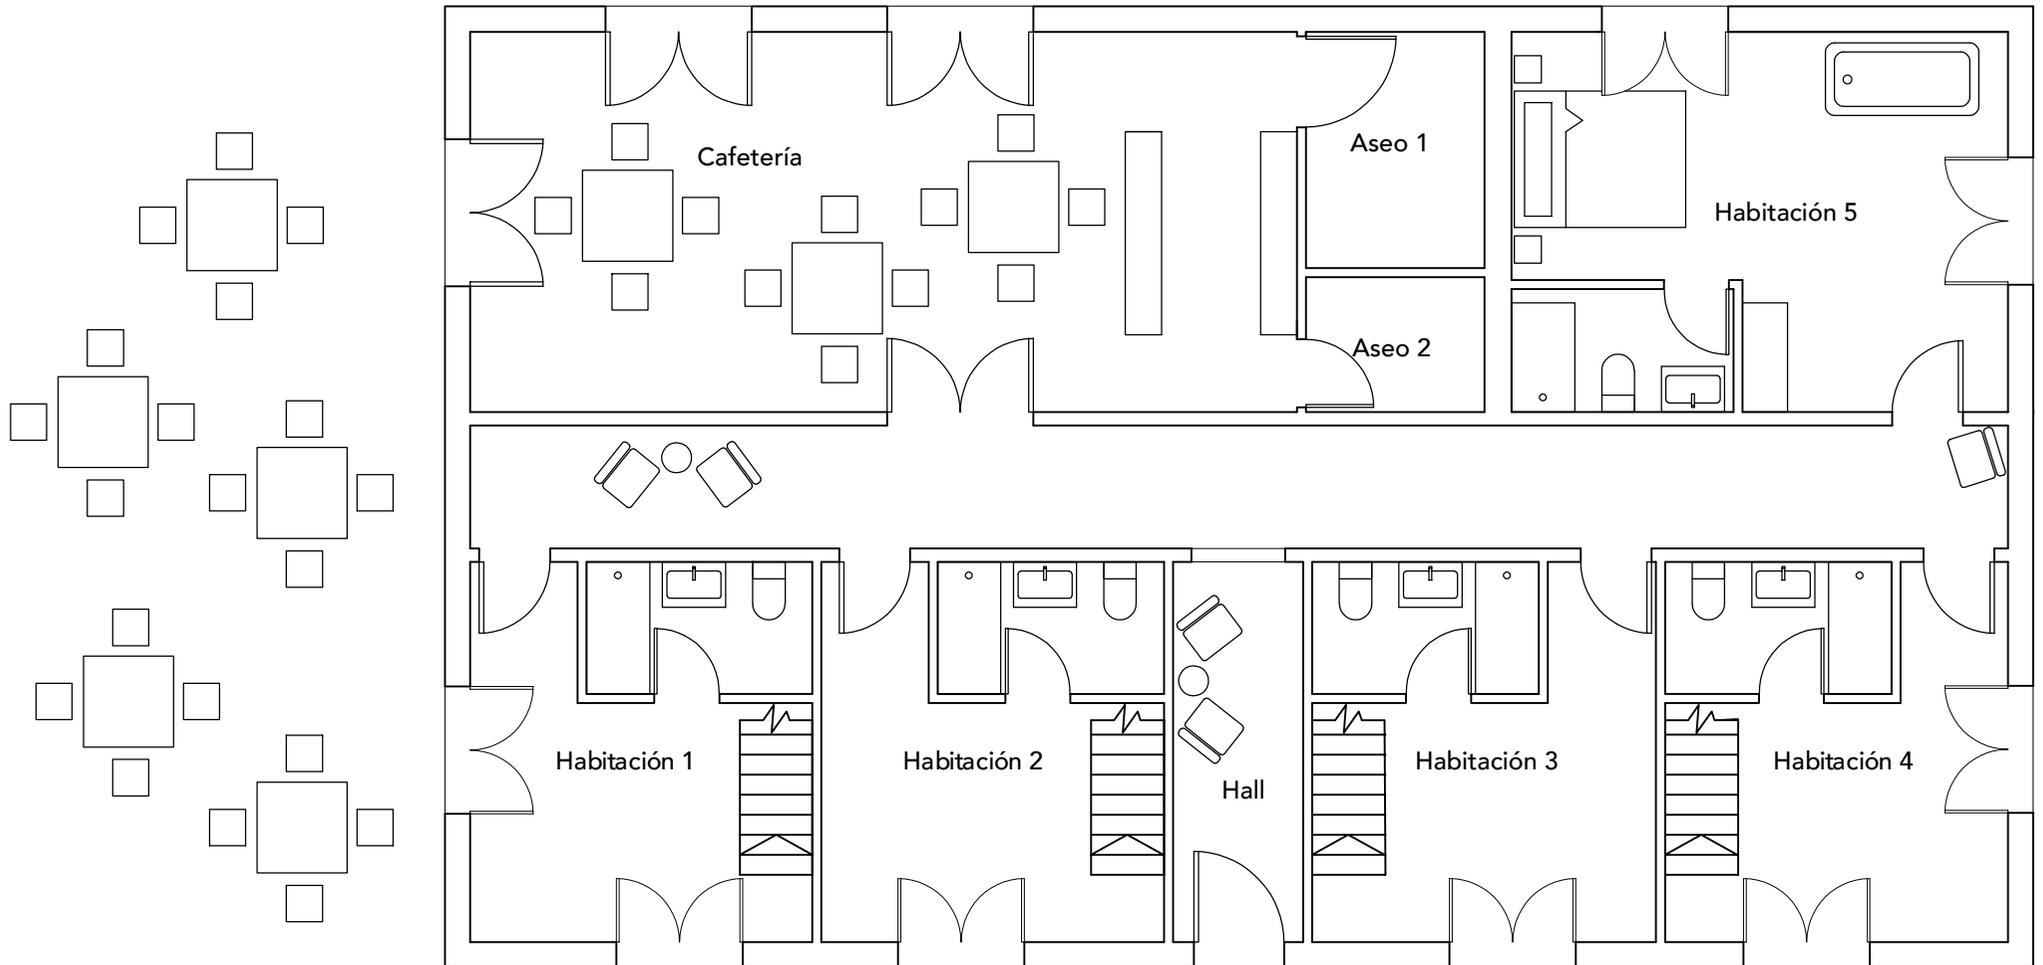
Plano Hotel trinidad. Planta baja. Sin escala.
